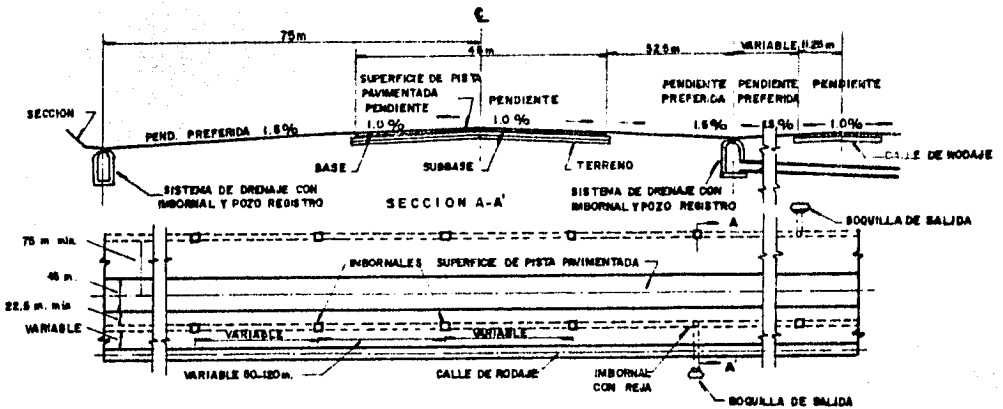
A DRENAJE ENTRE RODAJE Y PISTA
